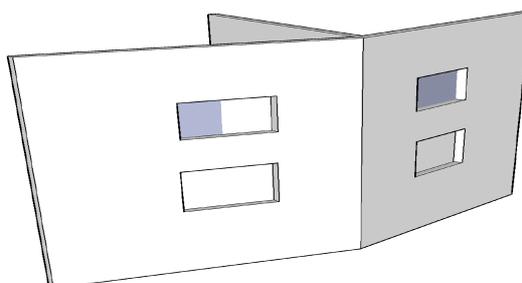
baies situées sur des façades différentes sans vision d'une baie sur l'autre
